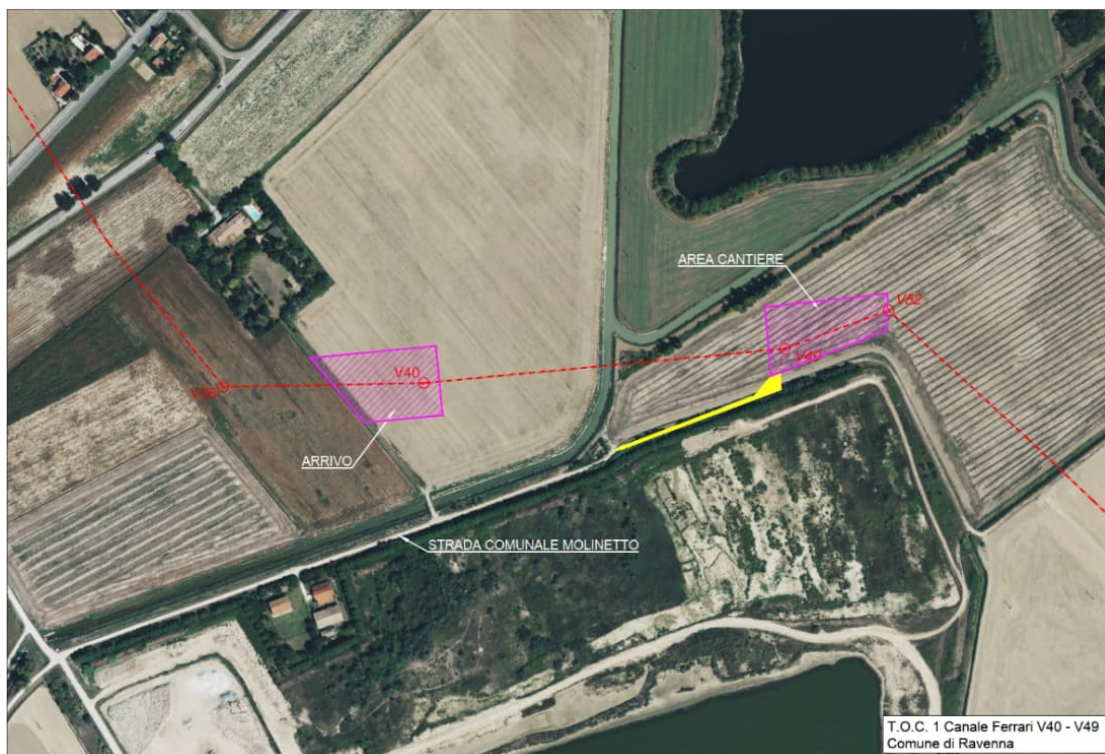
Tracciato di progetto (in rosso) ed identificazione delle aree di cantiere interessate dalla TOC "Canale Ferrari" con viabilità di accesso (in giallo)
